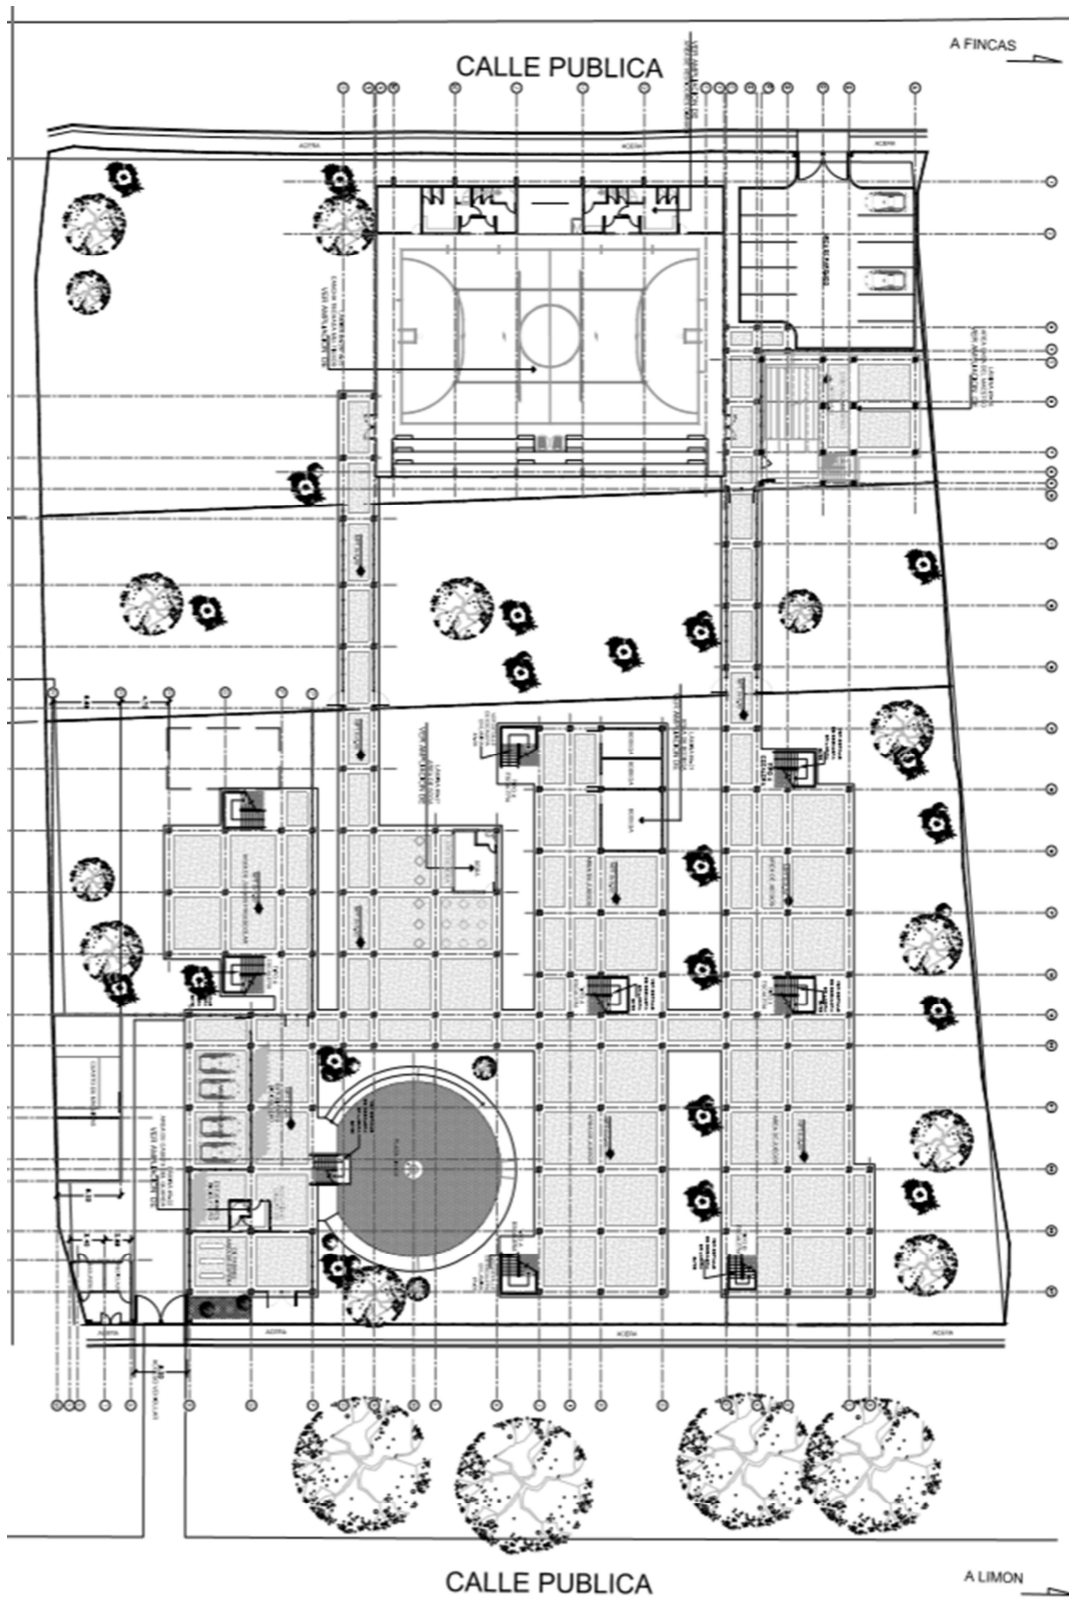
Planta arquitectónica primer nivel - Martínez, 2019.
